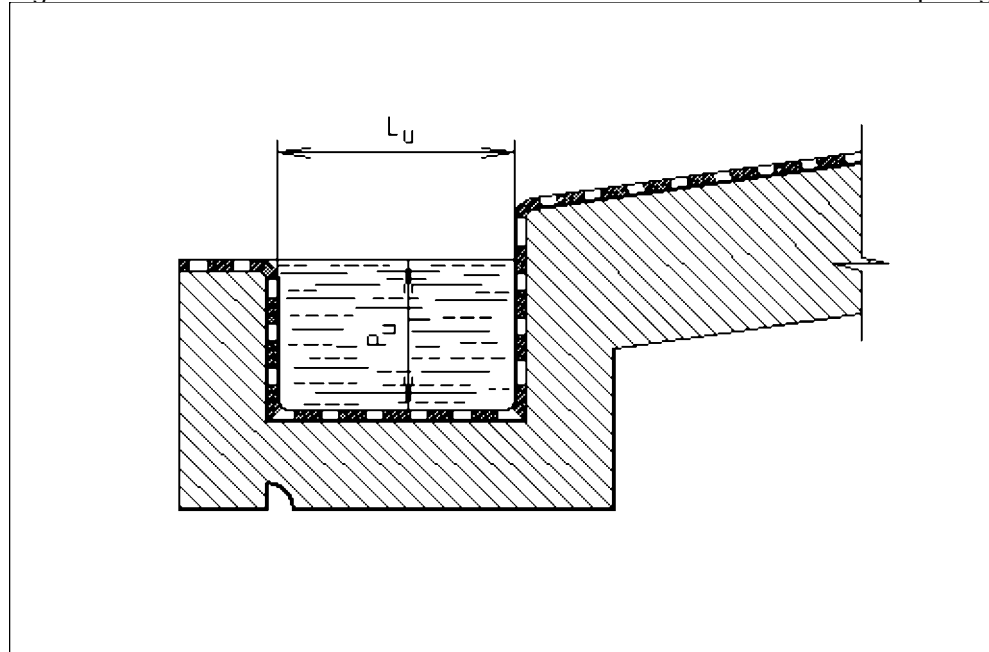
Chéneaux en encorbellement avec revêtement d'étanchéité autoprotégé
